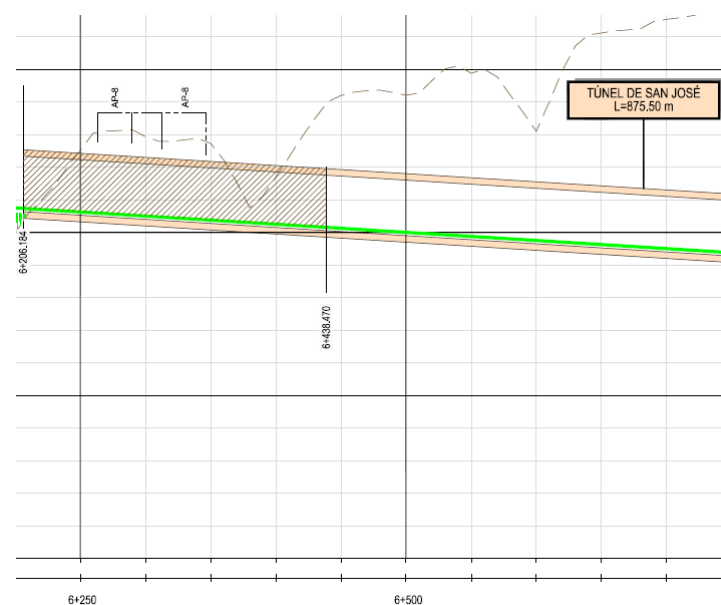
Situación del paso del túnel San José bajo la autopista AP-8 y la zona de baja cobertera del PK 6+600.
